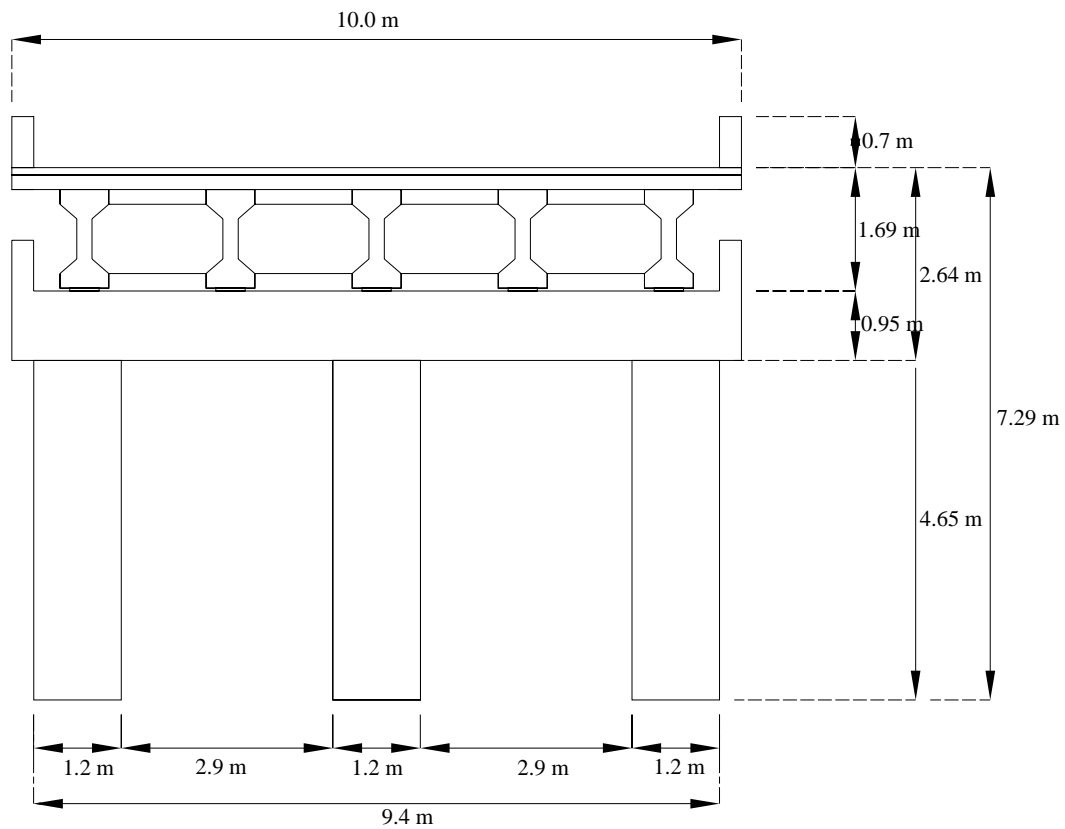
Parte central del puente PIV kilómetro 157+496 de la autopista: México-Maravatío
